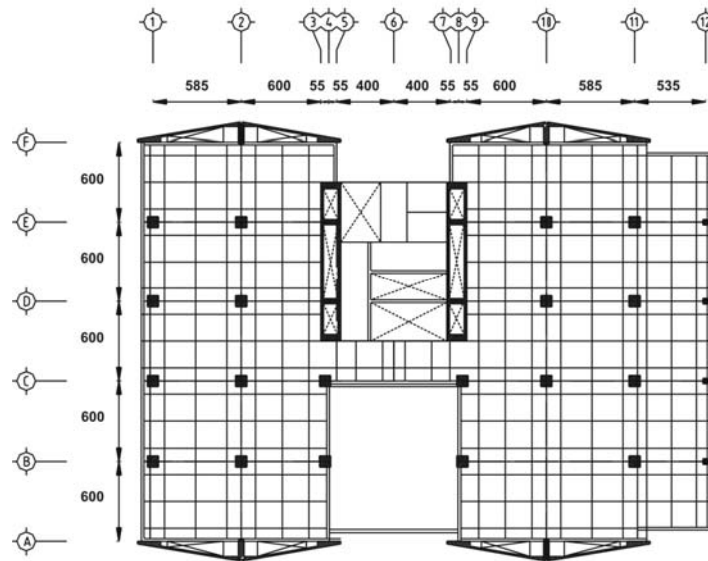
planta tipo del edificio Niveles 1 al 3
